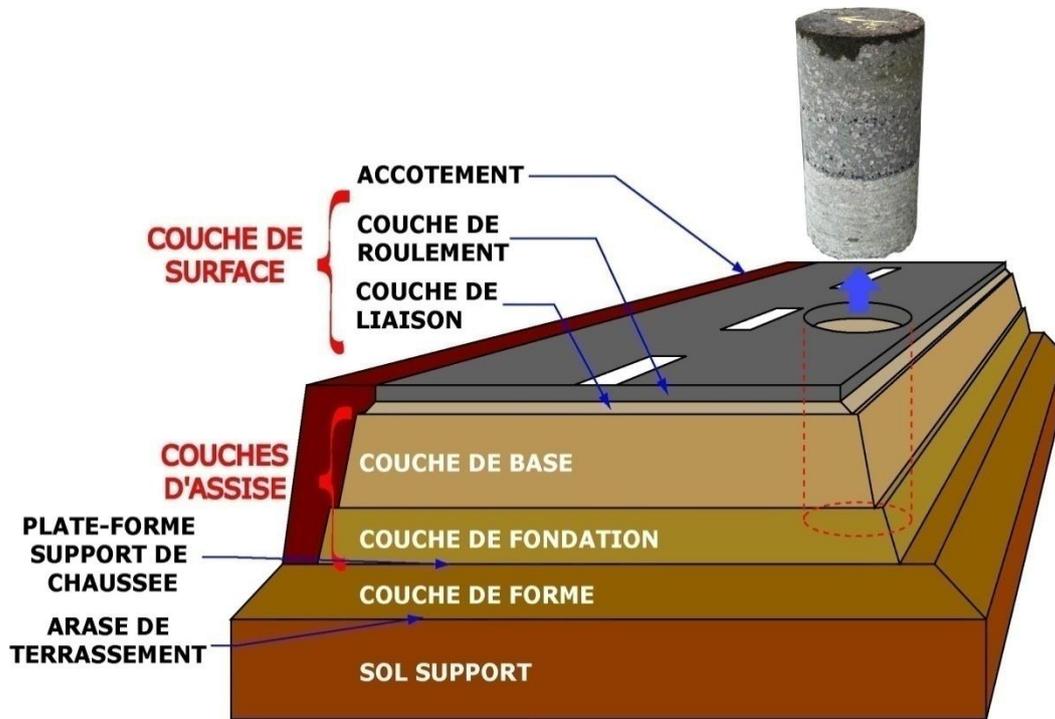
Les différentes couches d'une chaussée [Brosseaud Yves, 2009]
